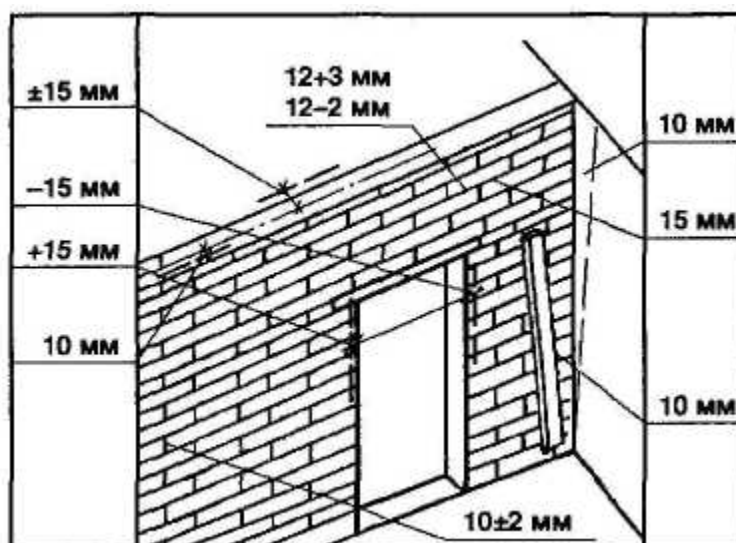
Допускаемые отклонения при кладке перегородок
